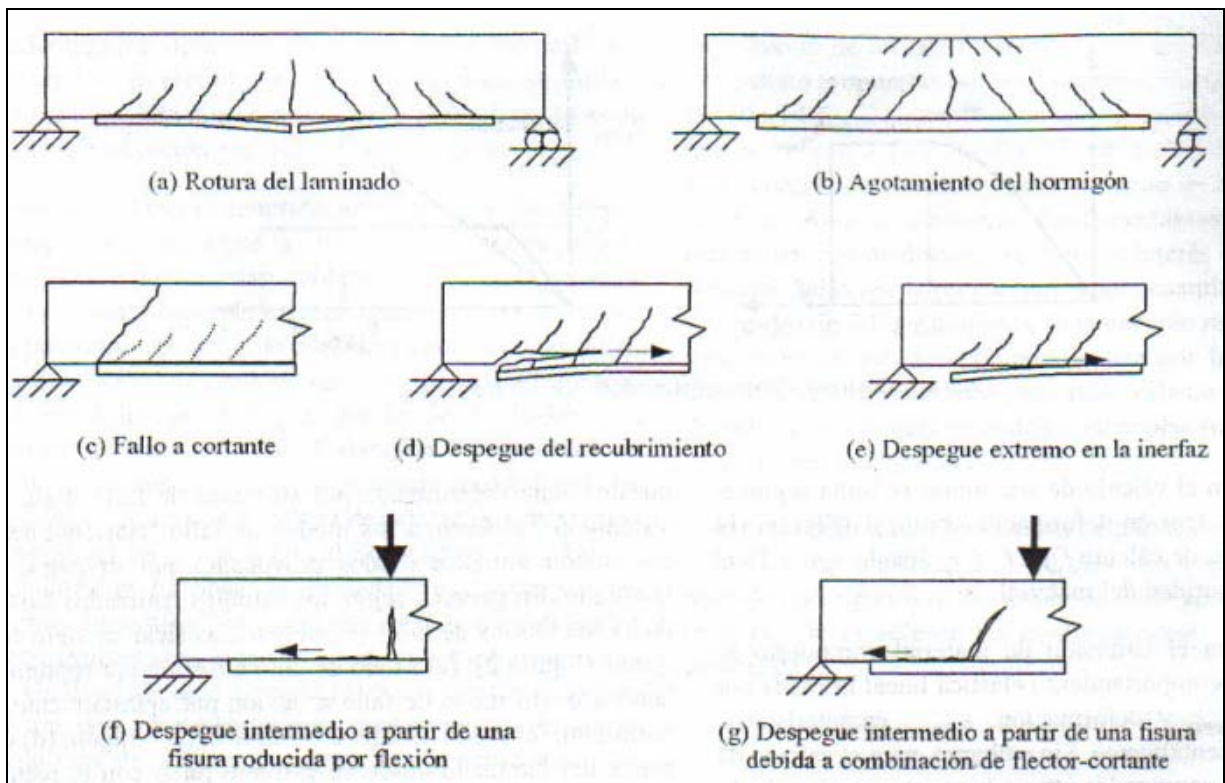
Models de fallida d'una biga de formigó armat reforçada amb un laminat (Font; [4])
